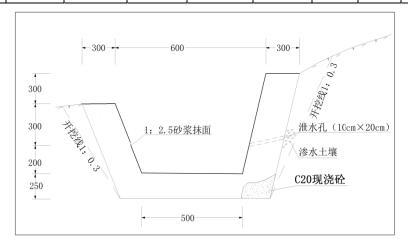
露采场终了境界外拟设截水沟断面示意图(单位: mm)
